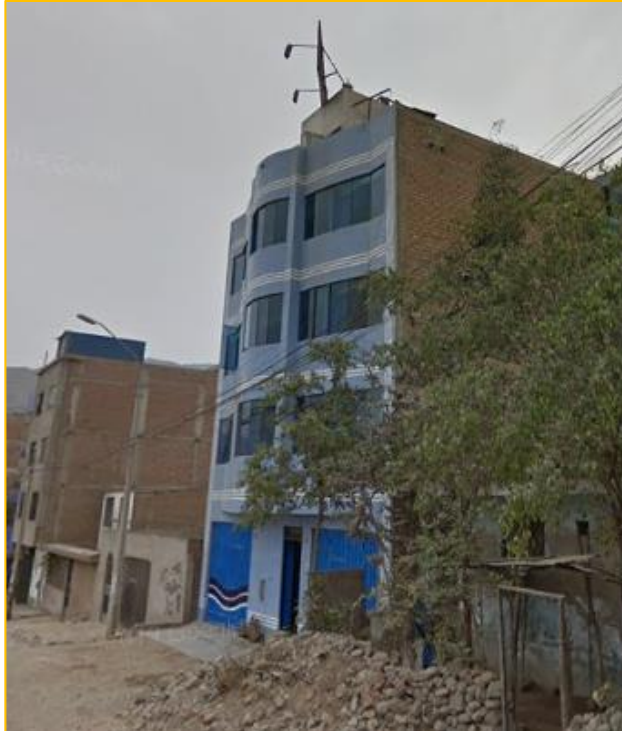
Nueva construcción de albañilería confinada, con asesoría técnica, según NTE E.070
